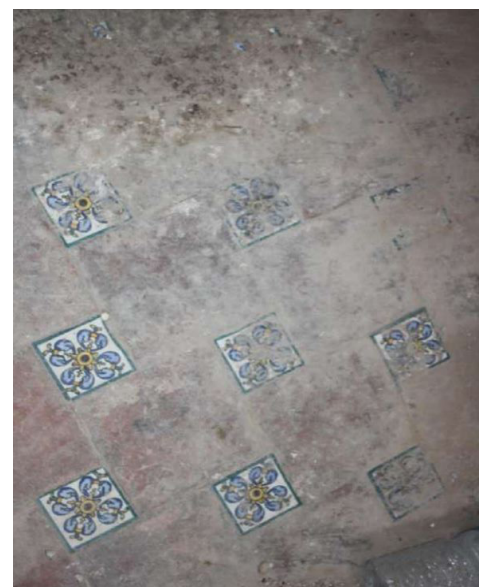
Vista de los restos del pavimento de la Alquería (12)
